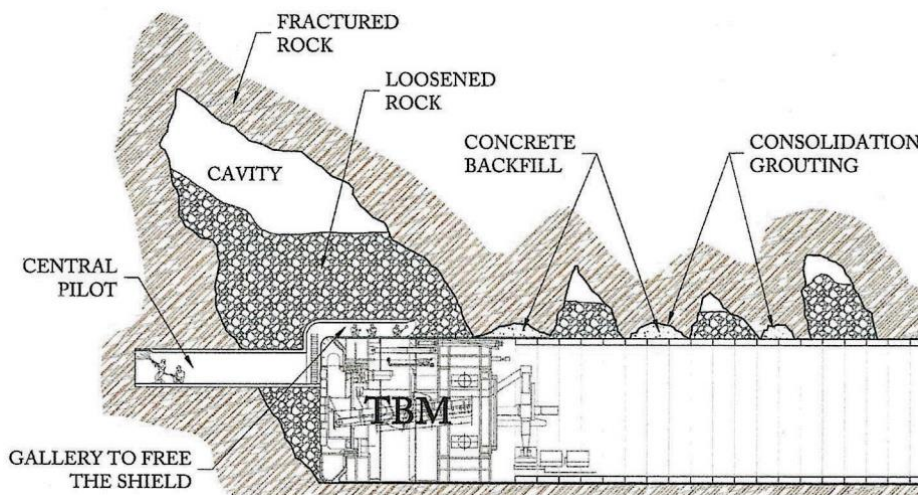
Detalle de la galería piloto excavada manualmente delante de una de las TBMS que trabajaban en la construcción del Túnel de Pinglin.
